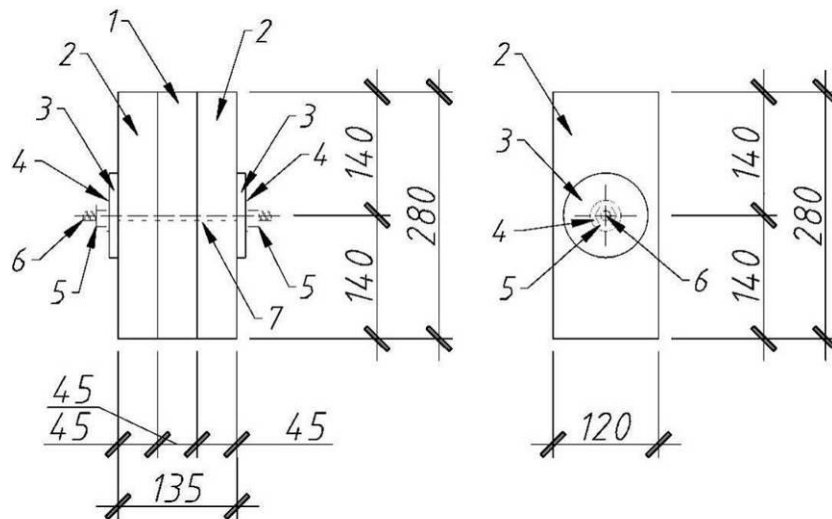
Схема образца для испытаний: 1 – центральный элемент; 2 – крайний элемент; 3 – траверс-шайба; 4 – кузовная шайба; 5 – гайка; 6 – винтовой стержень; 7 – зазор между стержнем и гнездом в древесине.
